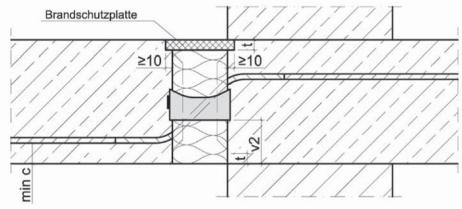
Schöck Isokorb® Typ Q (Ausführungsvariante C) gem. Abschnitt 3.1.2
